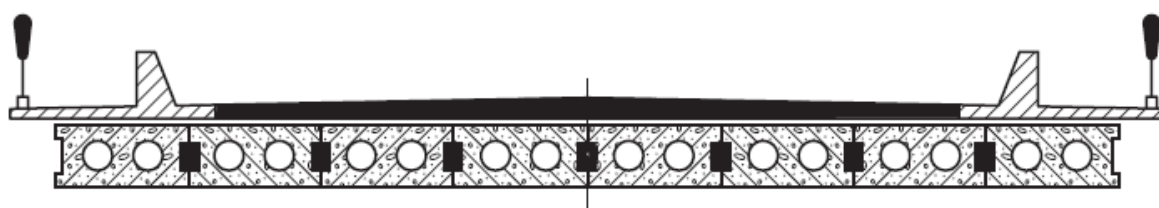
Компонка поперечного сечения плитного пролетного строения из блоков с круглыми пустотами
